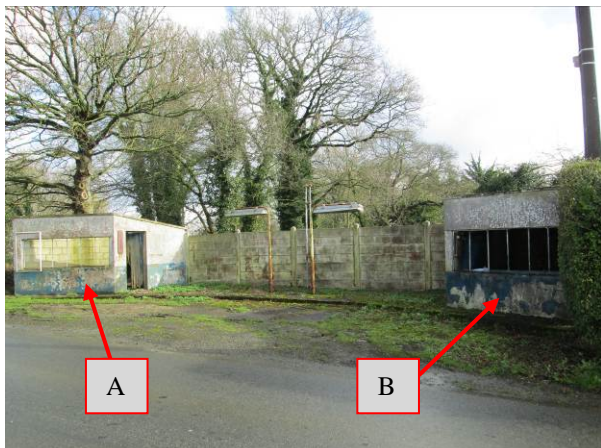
Vue des cabanons A et B de la parcelle AB 48. Façades Ouest
